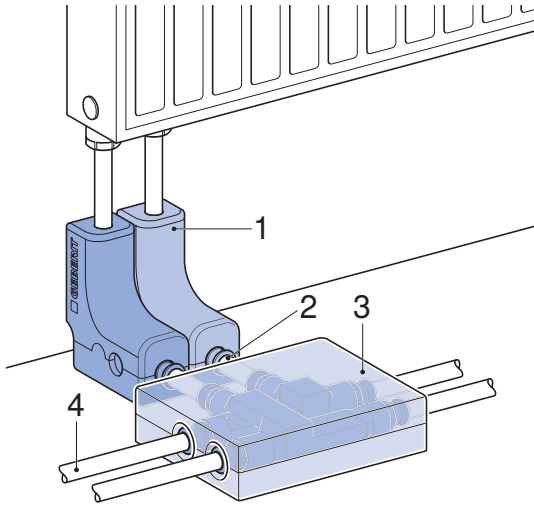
Conexión al radiador con recorrido de la tubería con distancia a la pared
